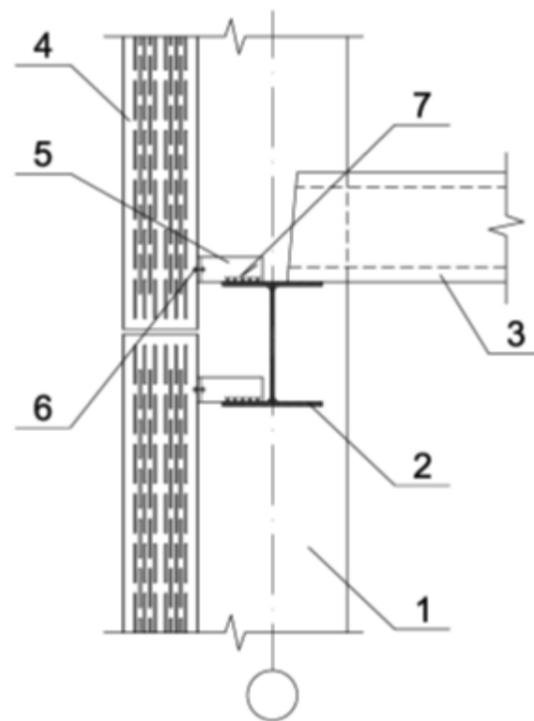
Узел крепления стоек каркаса стен к ригелю. 1-колонна, 2-ригель, 3- перекрытие, 4-стойка (термопрофиль), 5- соединительный элемент, 6- болт, гайка, шайбы.
